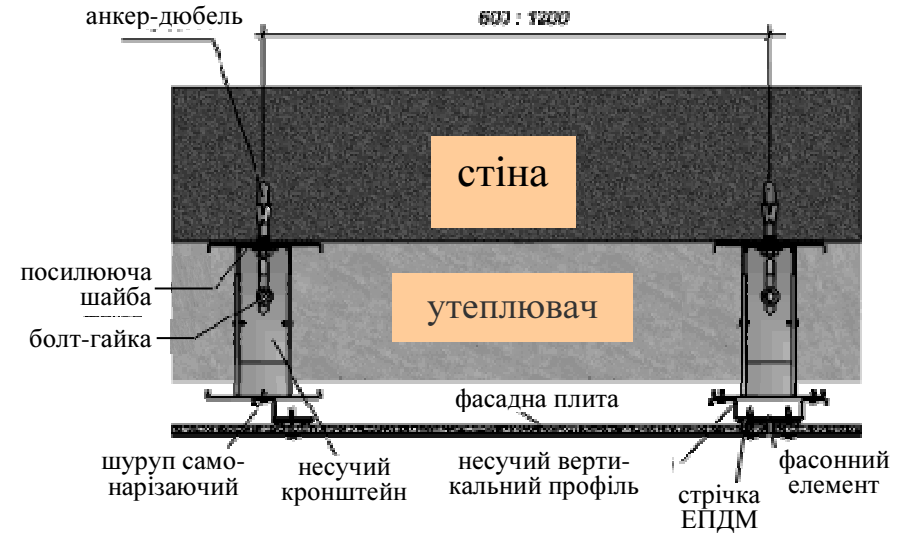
Кріплення фасадної плити до несучого профілю
